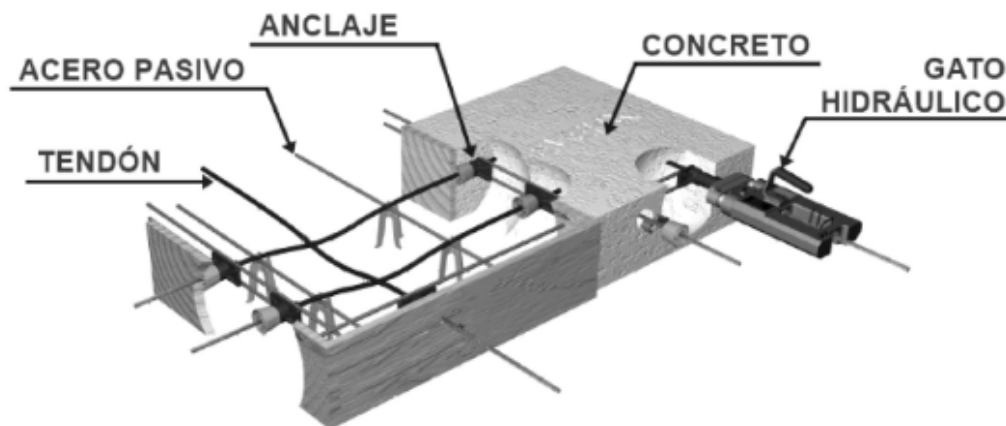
Diagrama de losa postensada. Fuente: Zamorano, Ingeniería Estructural, 2023
